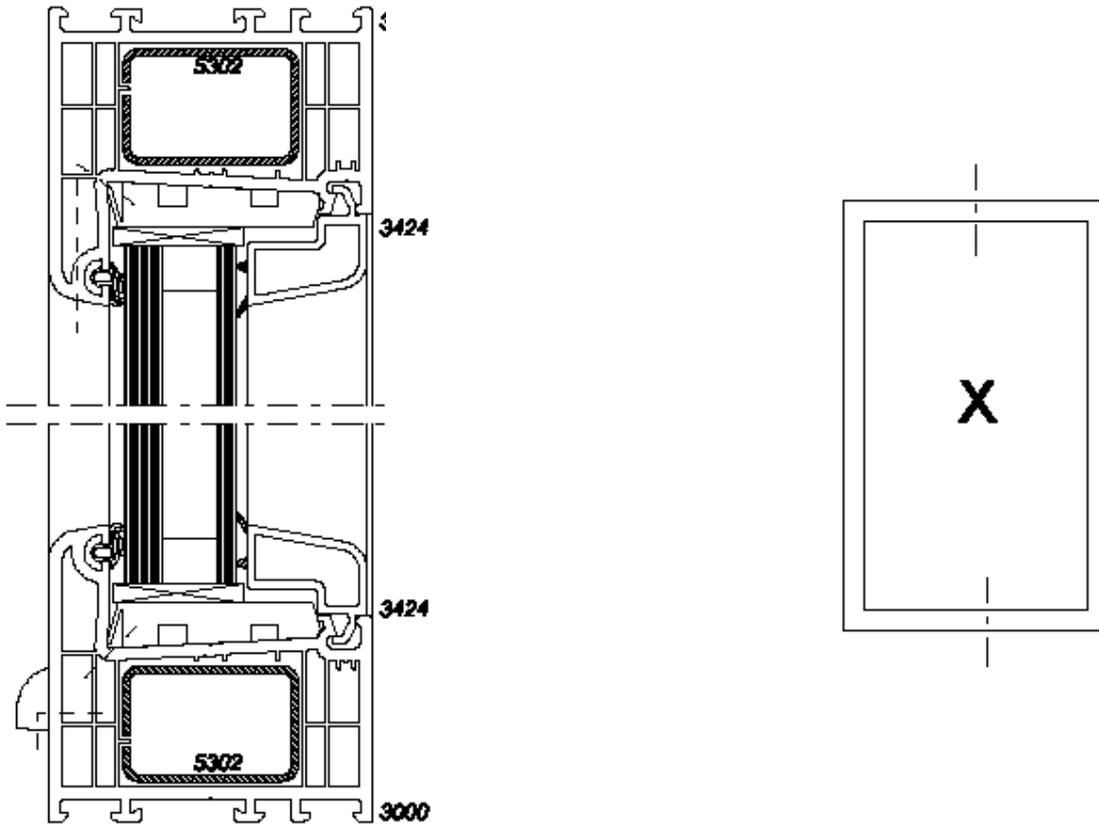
Coupe de la fenêtre fixe – Fenêtre ouvrante à la française
